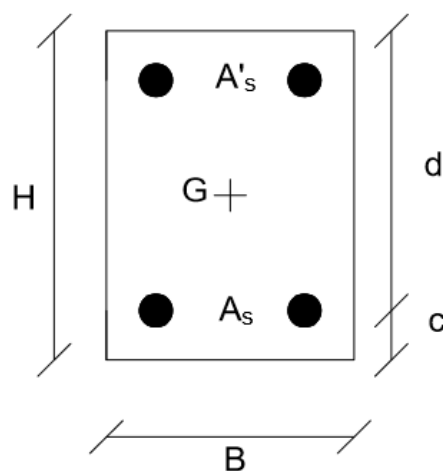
Sezione trasversale di un generico elemento in calcestruzzo armato.
